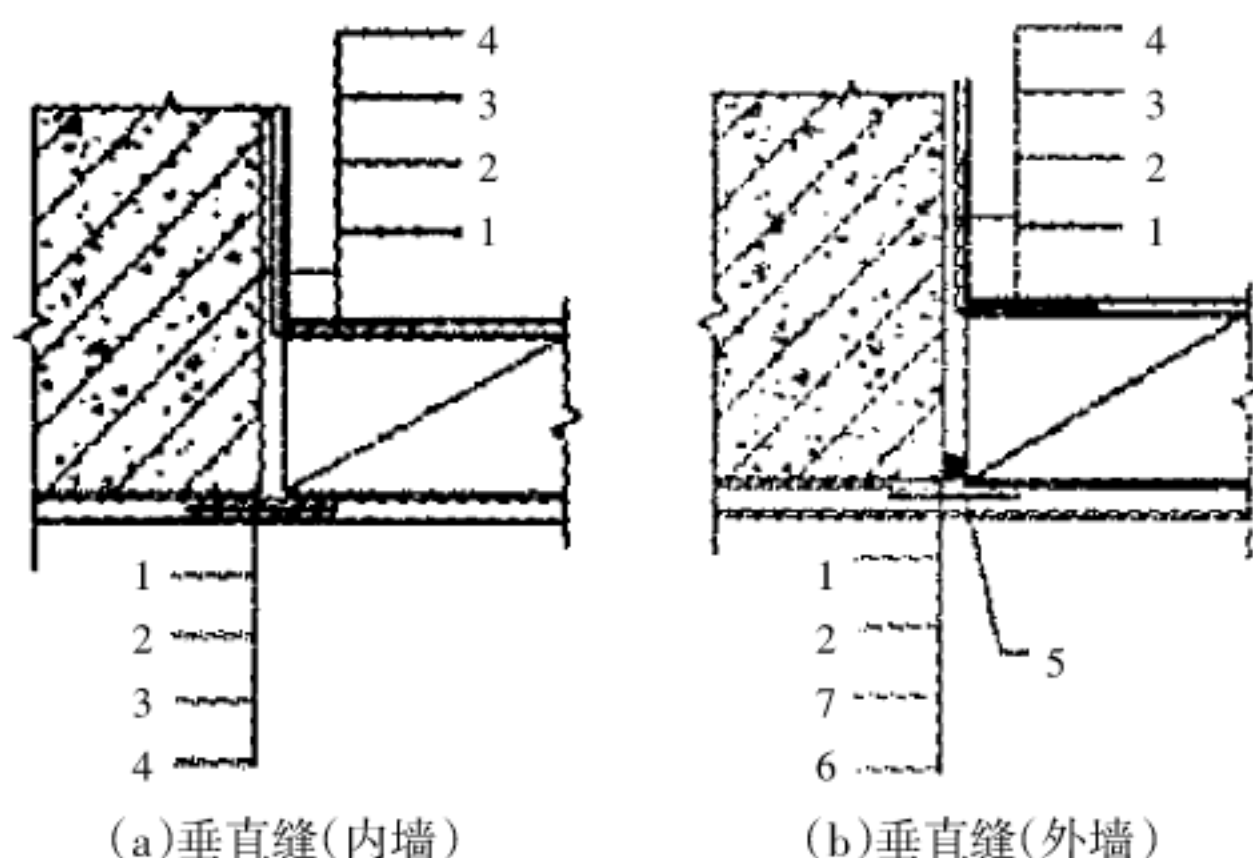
砌块墙与钢筋混凝土墙、柱连接处的缝隙处理
